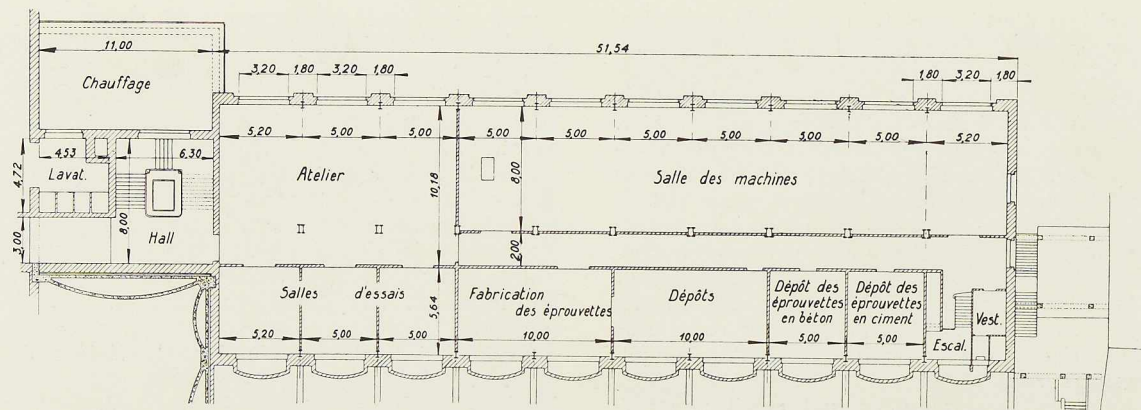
Vue en plan du Bloc 2, prise à hauteur du laboratoire de béton armé.
